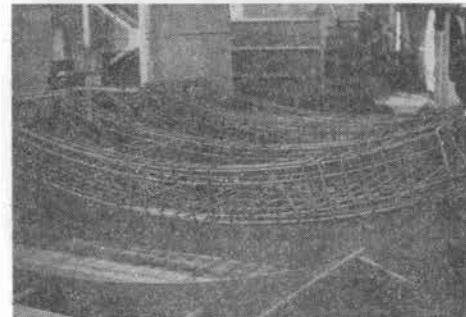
鉄筋コンクリートセグメントによる地下鉄トンネル (大阪)
